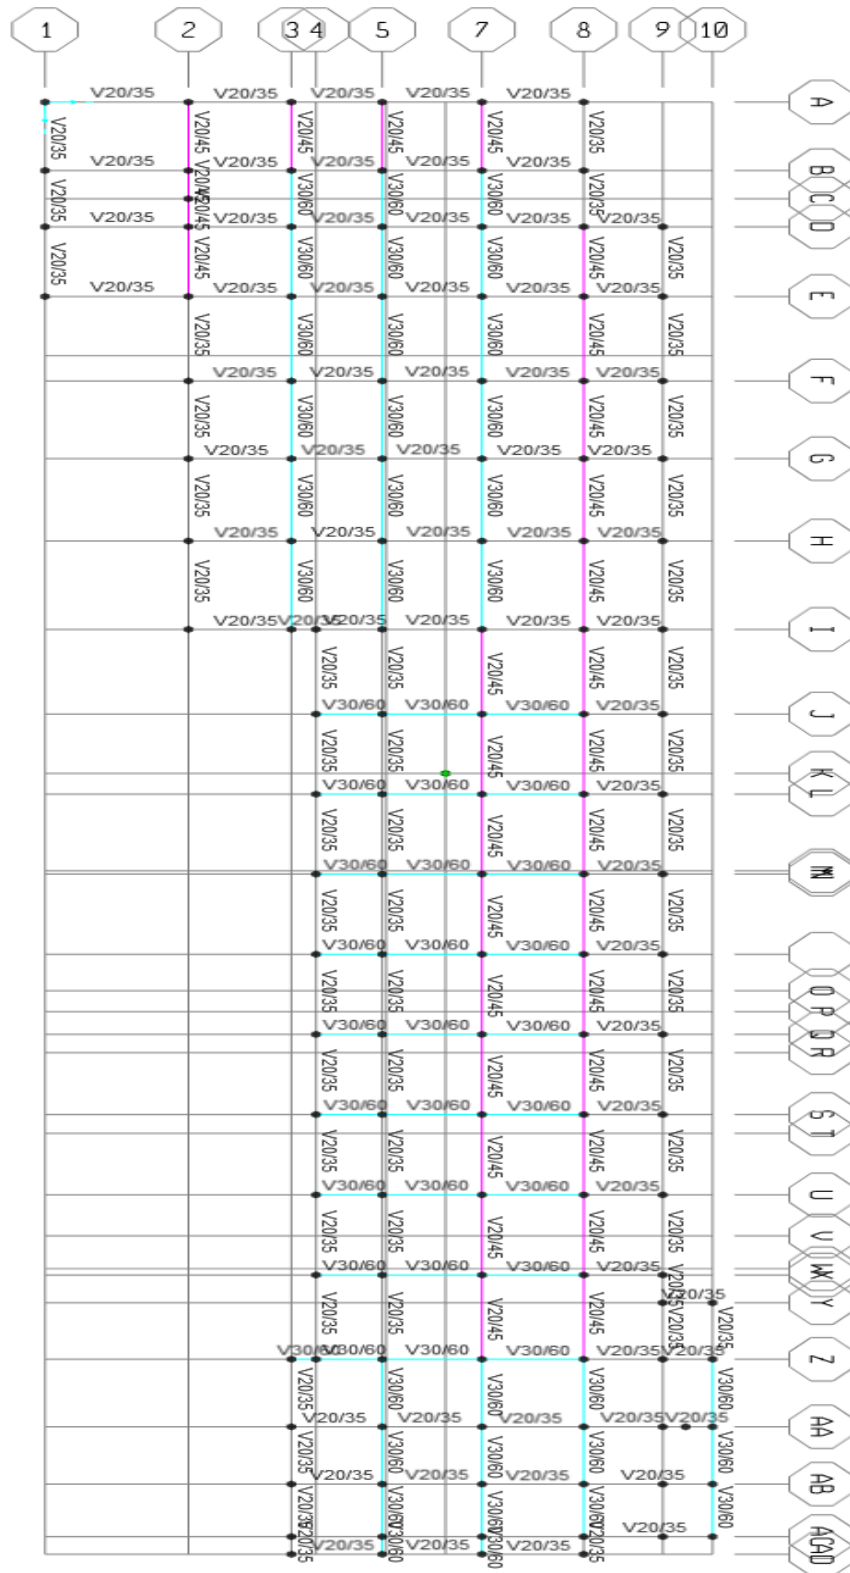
Vista 2da. Planta e identificación de elementos bloque B del Vicente Rocafuerte.
